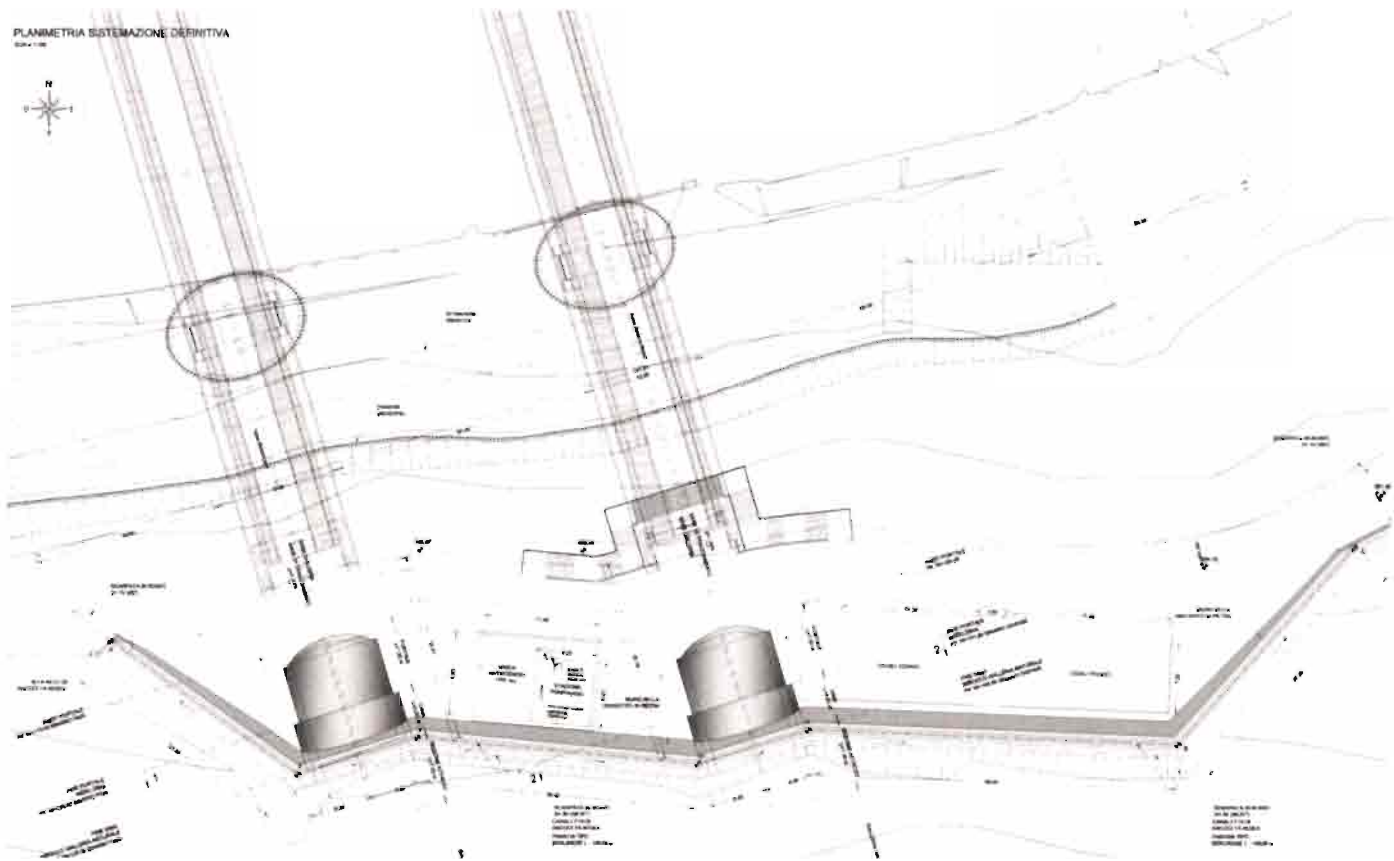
Gardena Nord - Stralcio planimetrico delle opere di imbocco.
